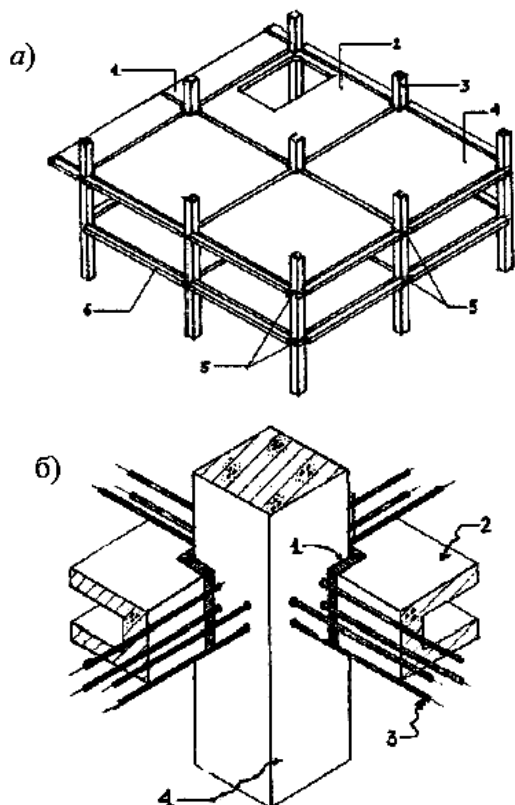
Несущий каркас системы ИМС. а) принципиальная конструкция каркаса: 1 – консольное перекрытие; 2 – перекрытие с отверстием для лестницы; 3 – колонна; 4 – типовое перекрытие; 5 – напрягаемая канатная арматура; 6 – фасадная распорка; б) конструкция узла примыкания плит перекрытия к колонне; 1 – контактный шов; 2 – плита; 3 – канат К-7; 4 – колонна
